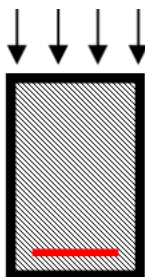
Exemplo da localização das armaduras tracionadas
